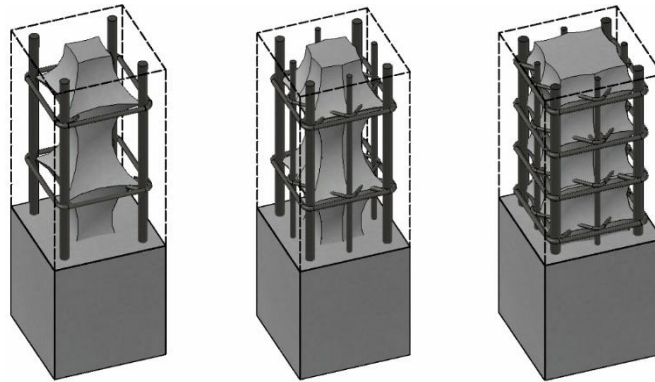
Umschnürter Betonkern von zentrisch belasteten Stahlbetonstützen
